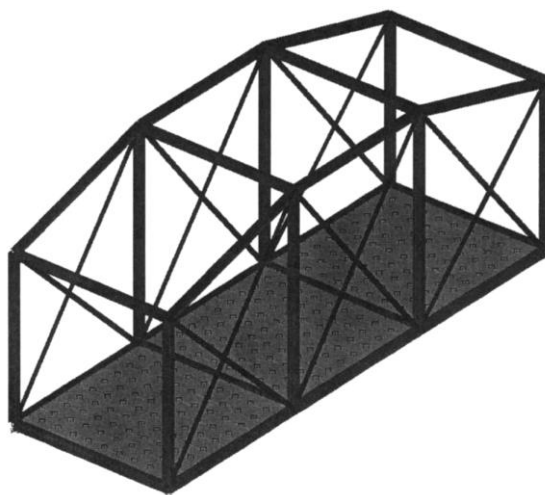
Стержнево-пластинчатая модель металлоконструкции
